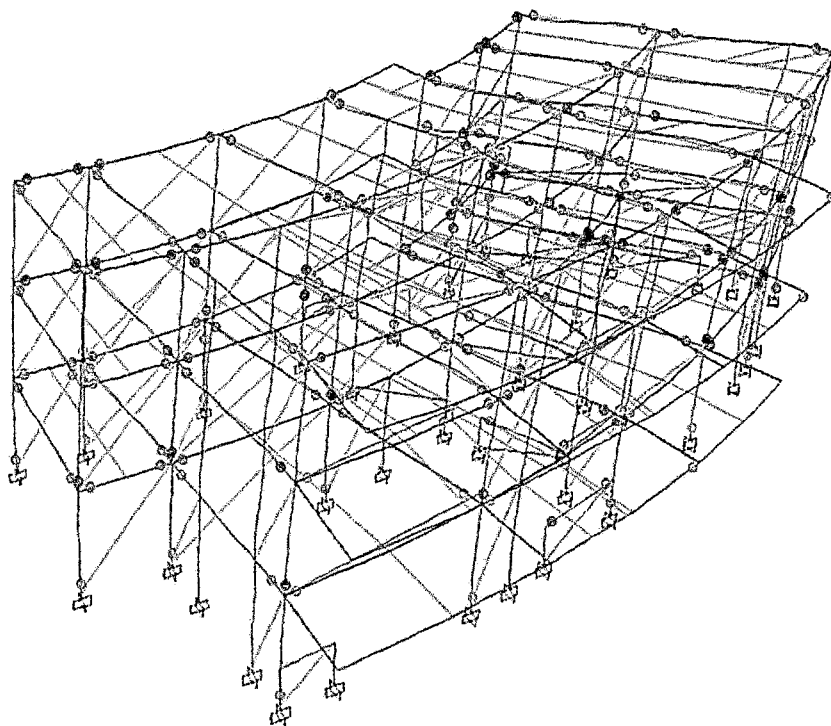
Formación de las Rótulas Plásticas Próximo al Colapso, Vista 3D
